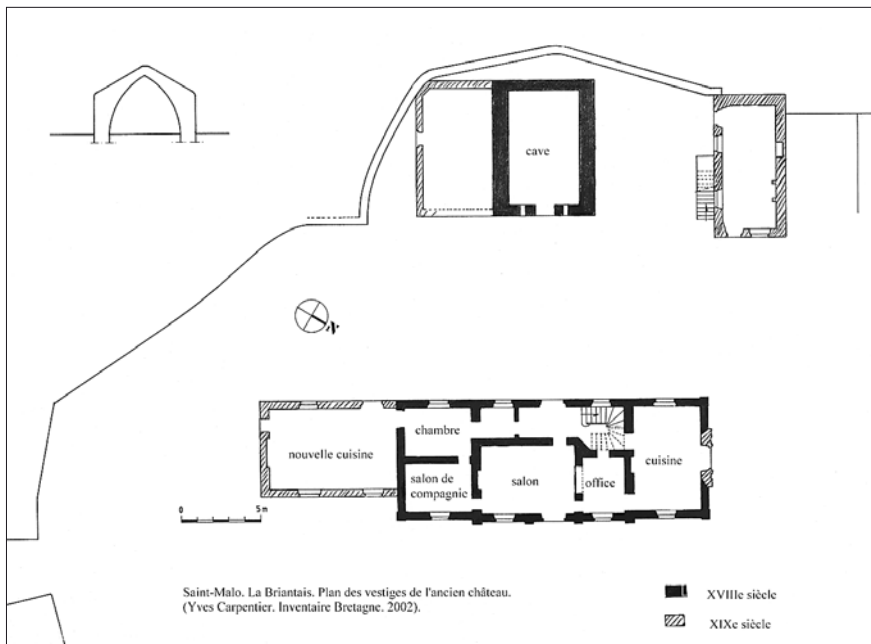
La Briantais, ancien château, plan au sol restitué (Yves Carpentier, Inventaire Région Bretagne)
